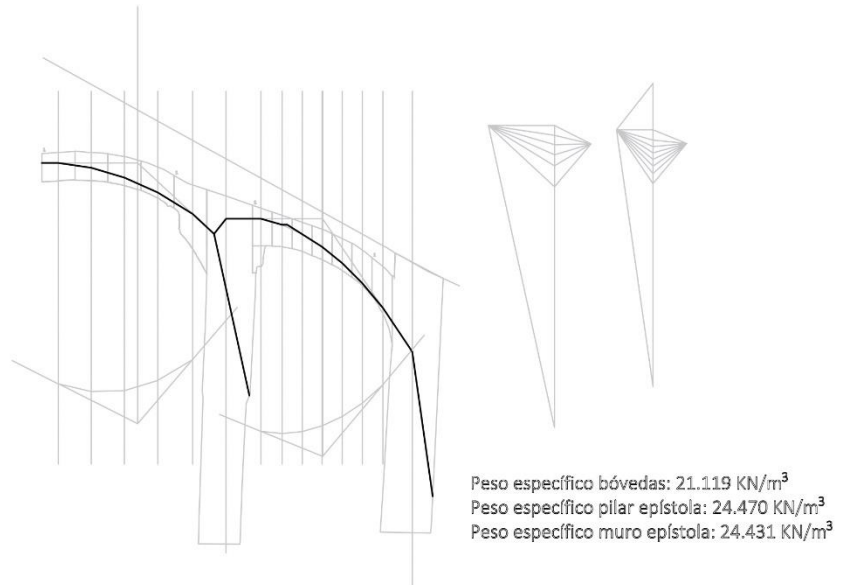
Estudio de la línea de presión por el plano de máxima inclinación del pilar P4 de Santa Eulària d'Unha
